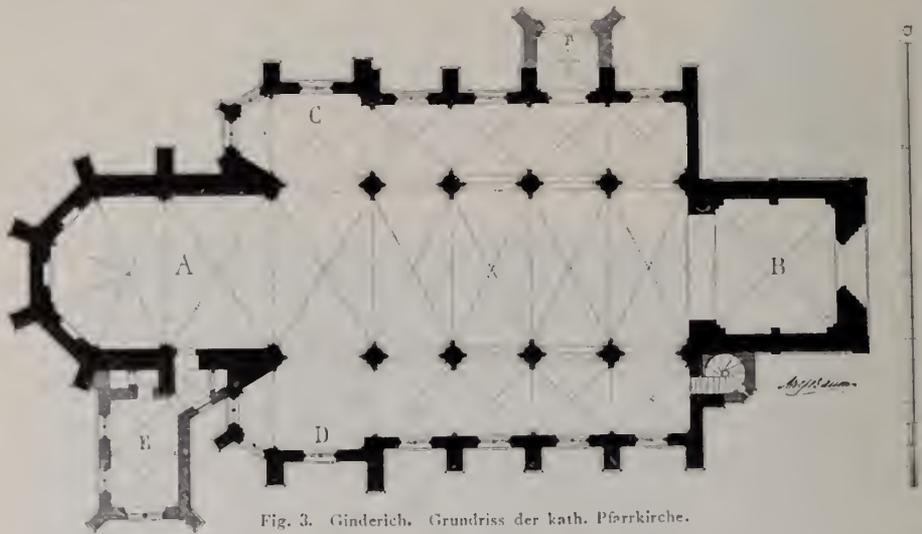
Ginderich. Grundriss der kath. Pfarrkirche.
